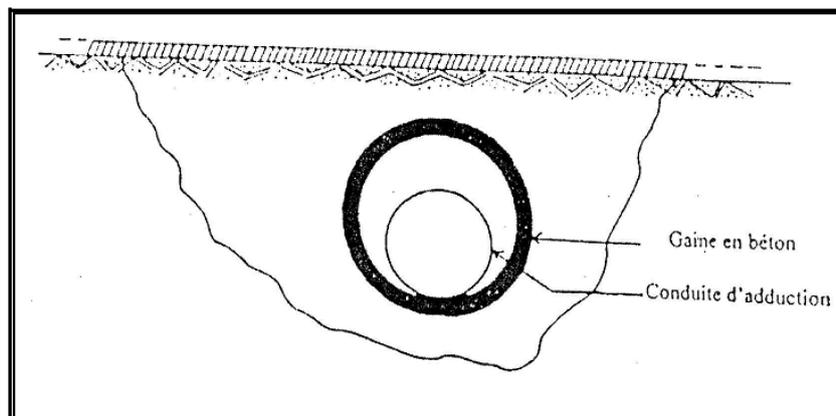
Traversée d'une route au moyen d'une gaine [10]
